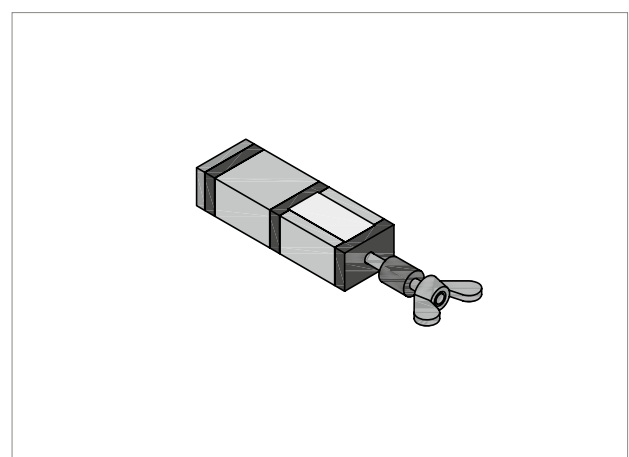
Schöck Tronsole® Typ Q: Montageelement
